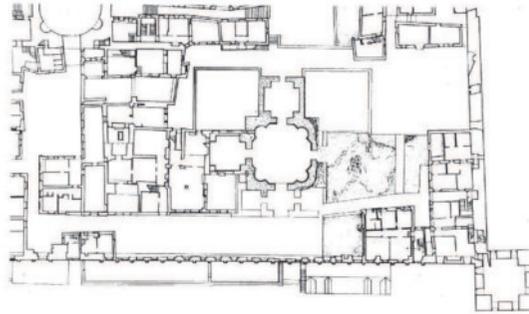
, Der südöstliche Teil des Palastes - Grundriss Erdgeschoß
